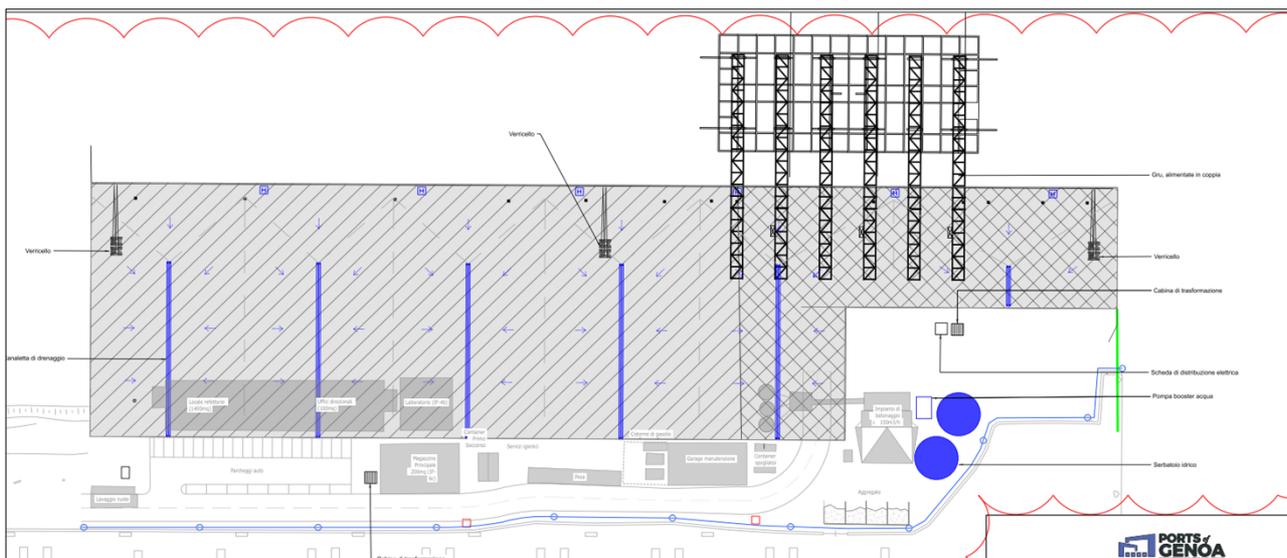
Planimetria delle installazioni di cantiere dell'area di Prà
